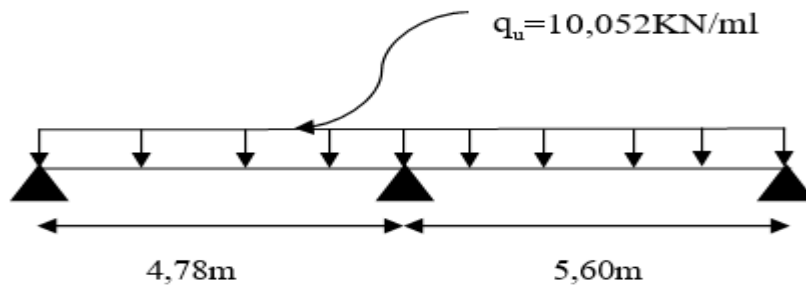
Coupe transversale de la poutrelle à 2 travées
